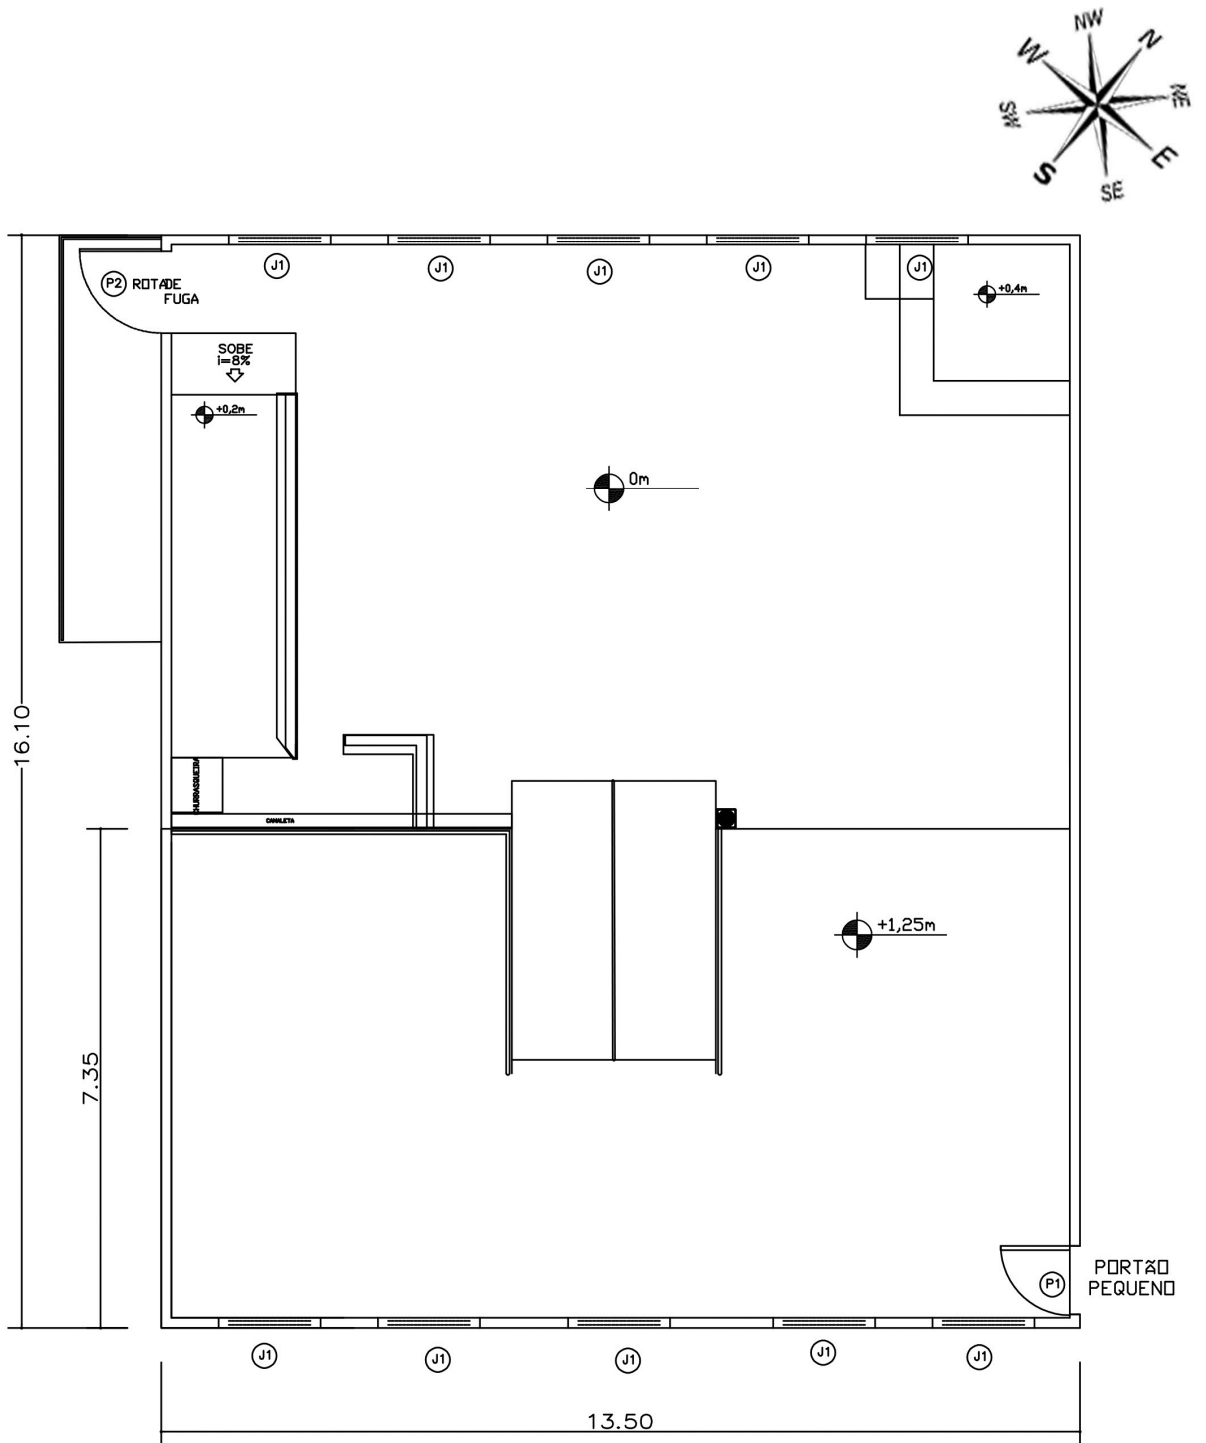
Planta baixa 2D e localização cardinal do salão de festas.
